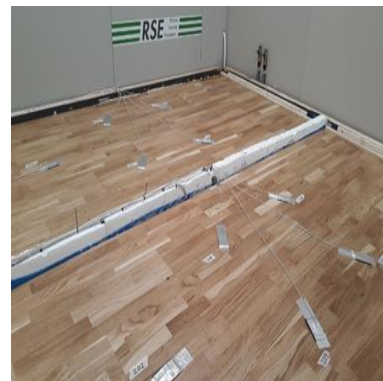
Vista in pianta del laboratorio e collocazione del pavimento radiante e dei fancoili.
